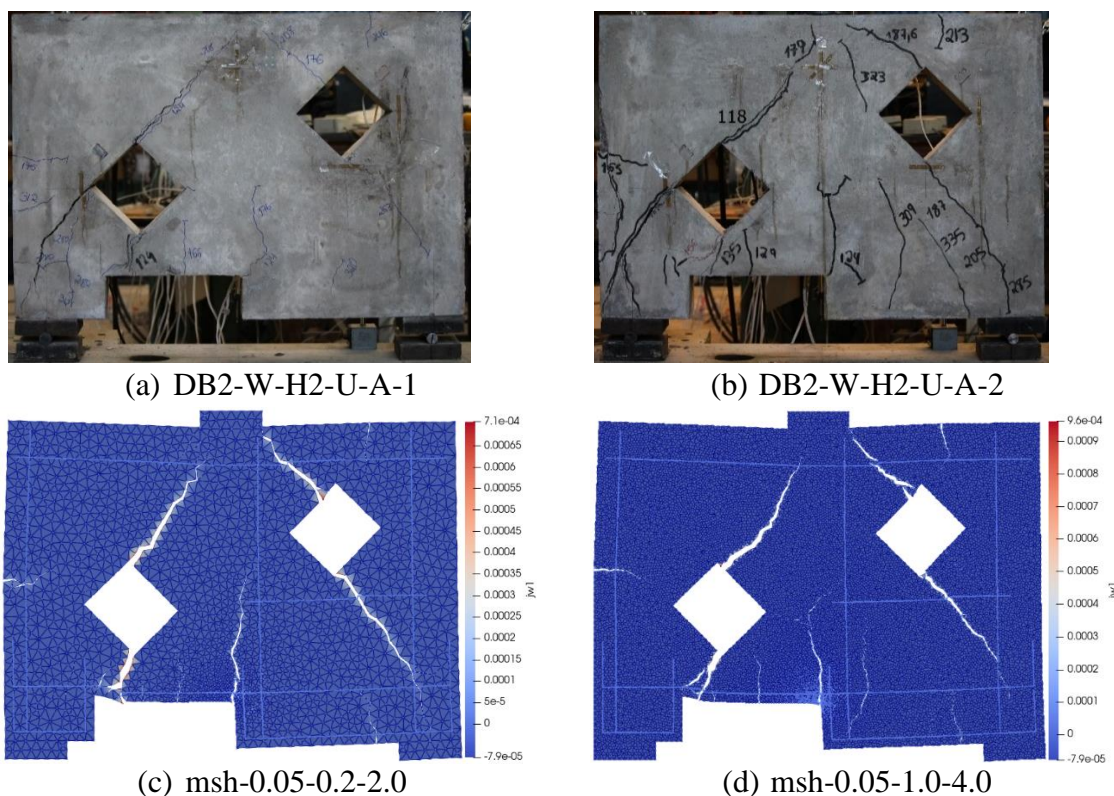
Deformada e padrão de fissuração (abertura direcional das fissuras) para as vigas-parede da Série 2 com duas aberturas e com armadura na alma
